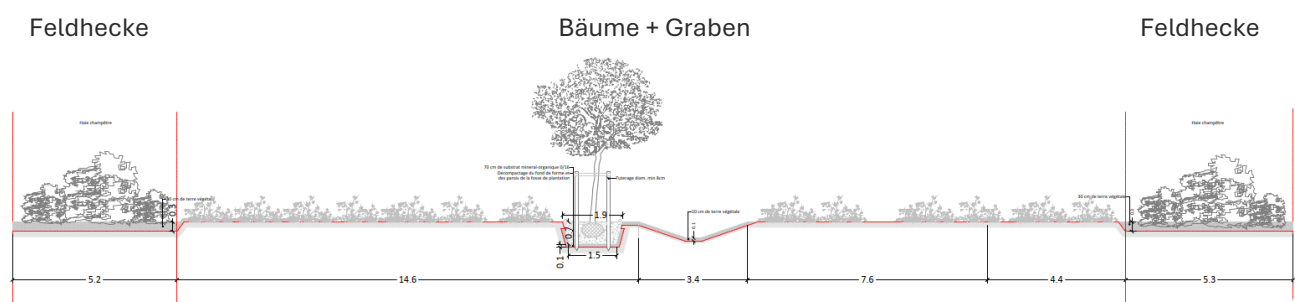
Detail D-D des Plan de Plantation, Grünkorridor im Bereich der Retentionsbecken (Quelle: Papaya Sàrl 2025). Größere Darstellung in Anhang 06a.
